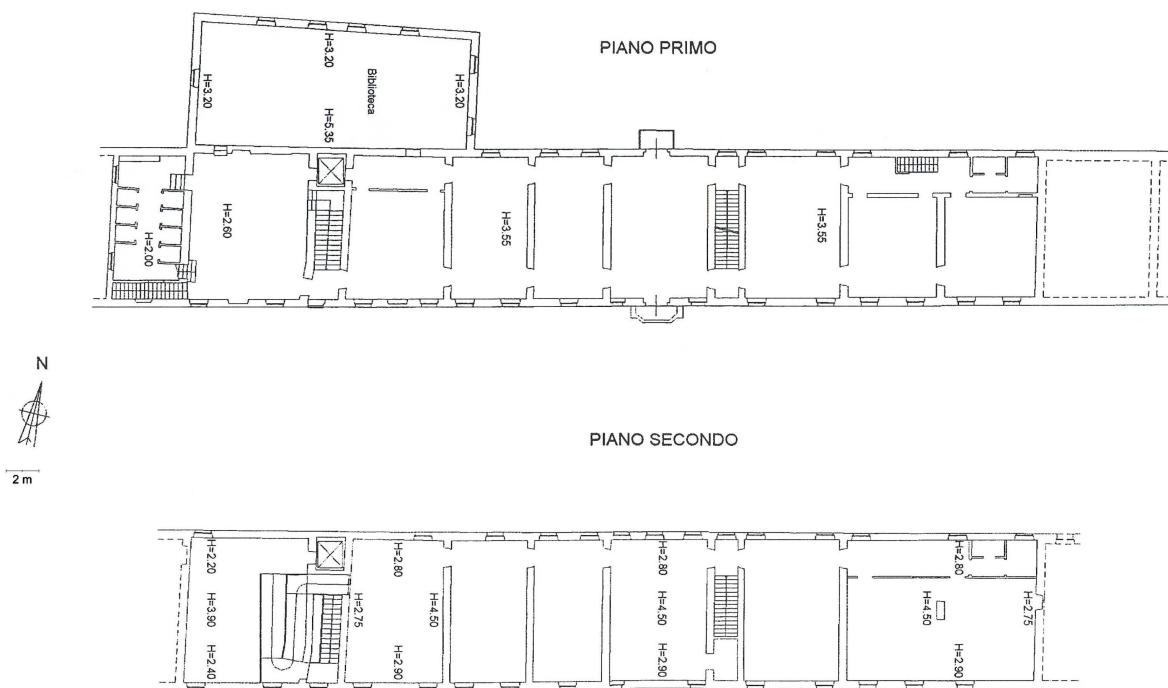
Corpo padronale: pianta piano nobile e mezzanino. Stato attuale
